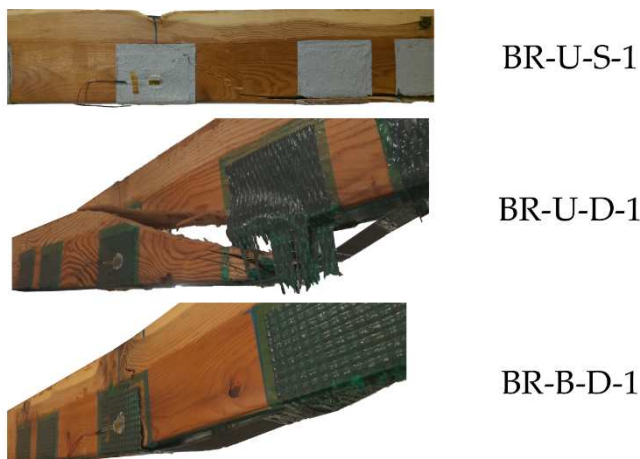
Imágenes de las roturas de las vigas del grupo BR. Arriba: BR-U-S-1. Centro: BR-U-D-1. Abajo: BR-B-D-1.
